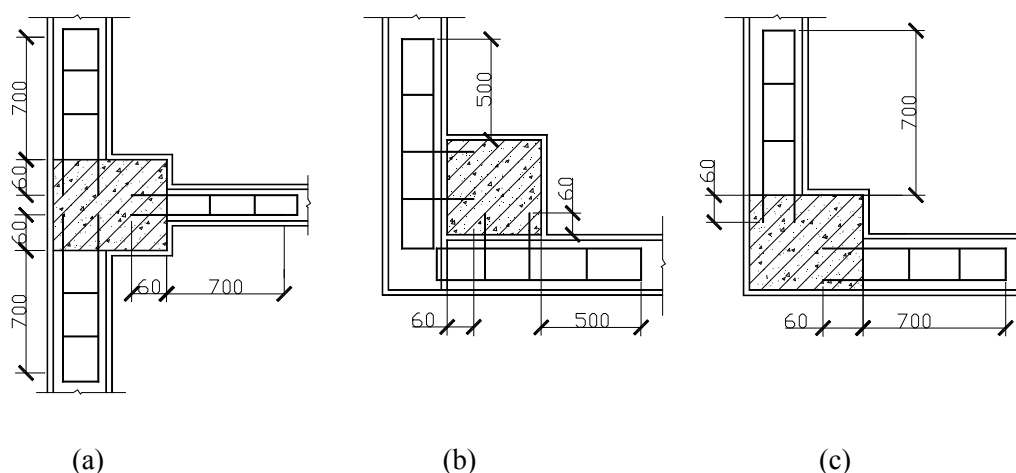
砌体墙体与钢筋混凝土柱或剪力墙的拉结
